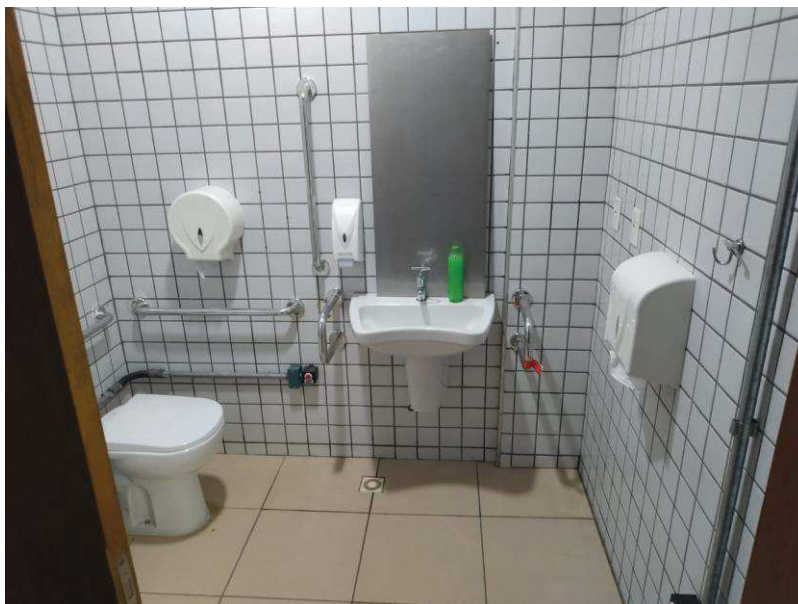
Portas dos banheiros acessíveis do segundo pavimento
